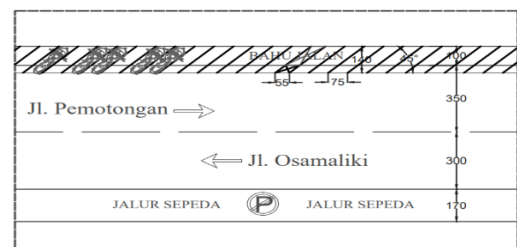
Detail A Alternatif Simulasi Parkir III
